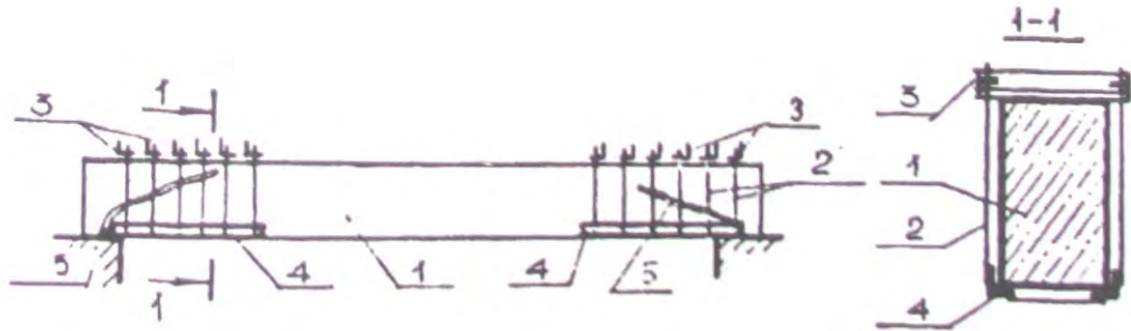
Металева обойма підсилення похилих перерізів залізобетонної балки:
